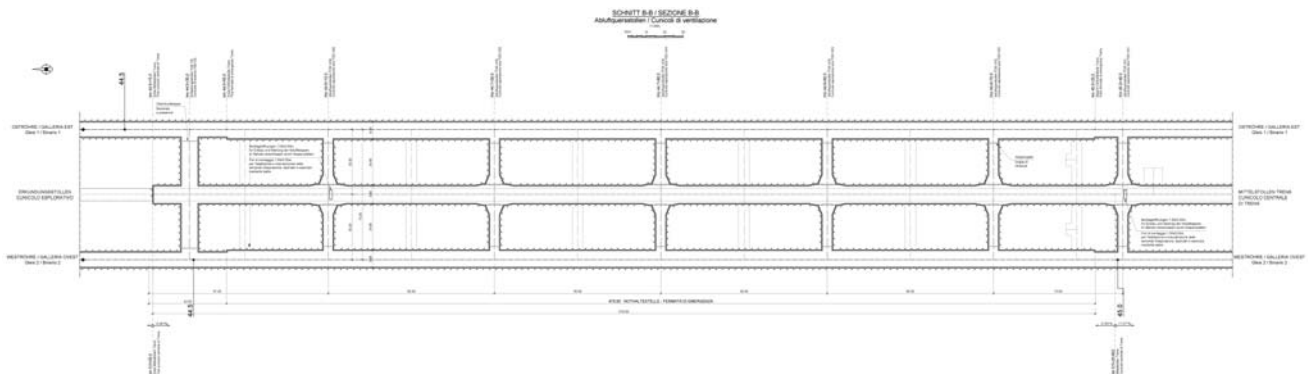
Übersichtsplan Nothaltestelle [43], Lageplan mit Infrastrukturen
